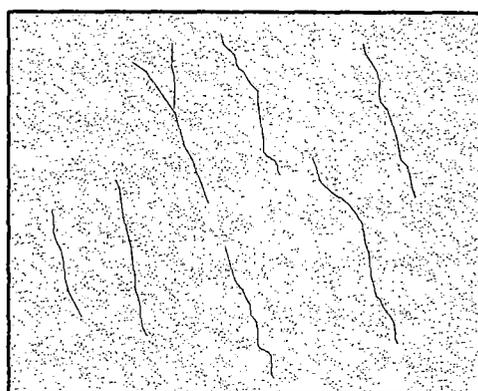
Agrietamiento de una losa por retracción plástica.
